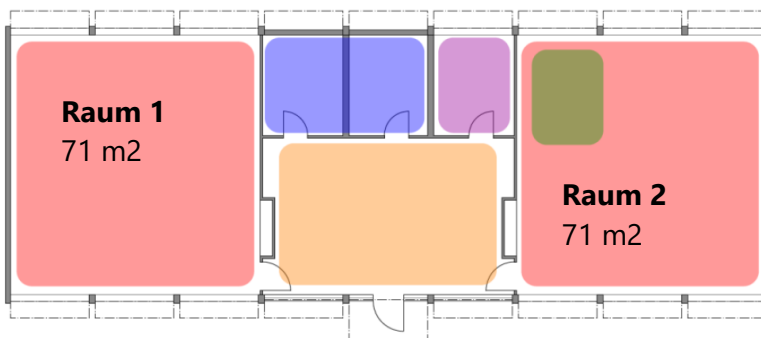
Grundriss Variel-Pavillon mit symmetrischer Raumanordnung
